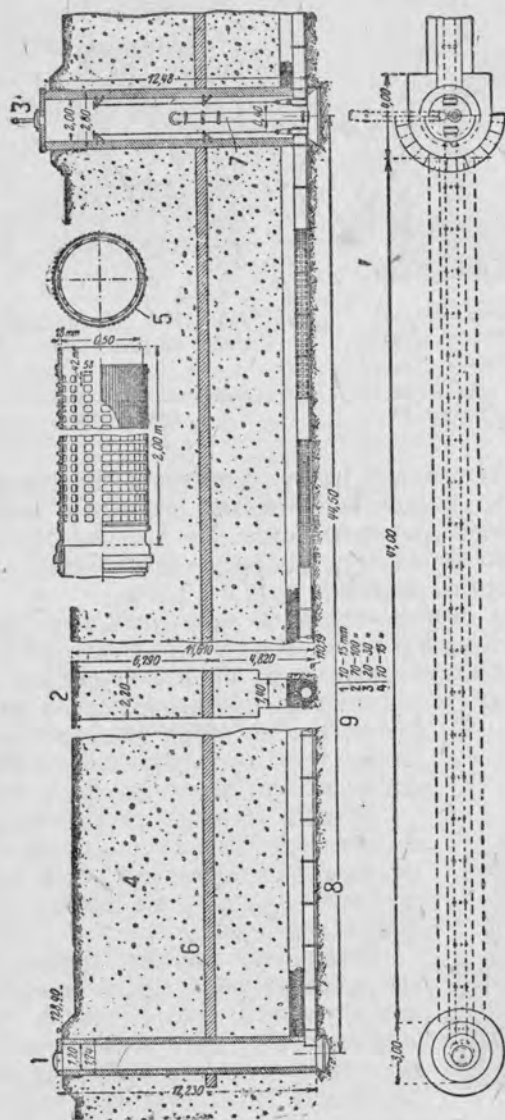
Чугунный дренаж водопровода города Трира, близ Кенна (по Валу).
